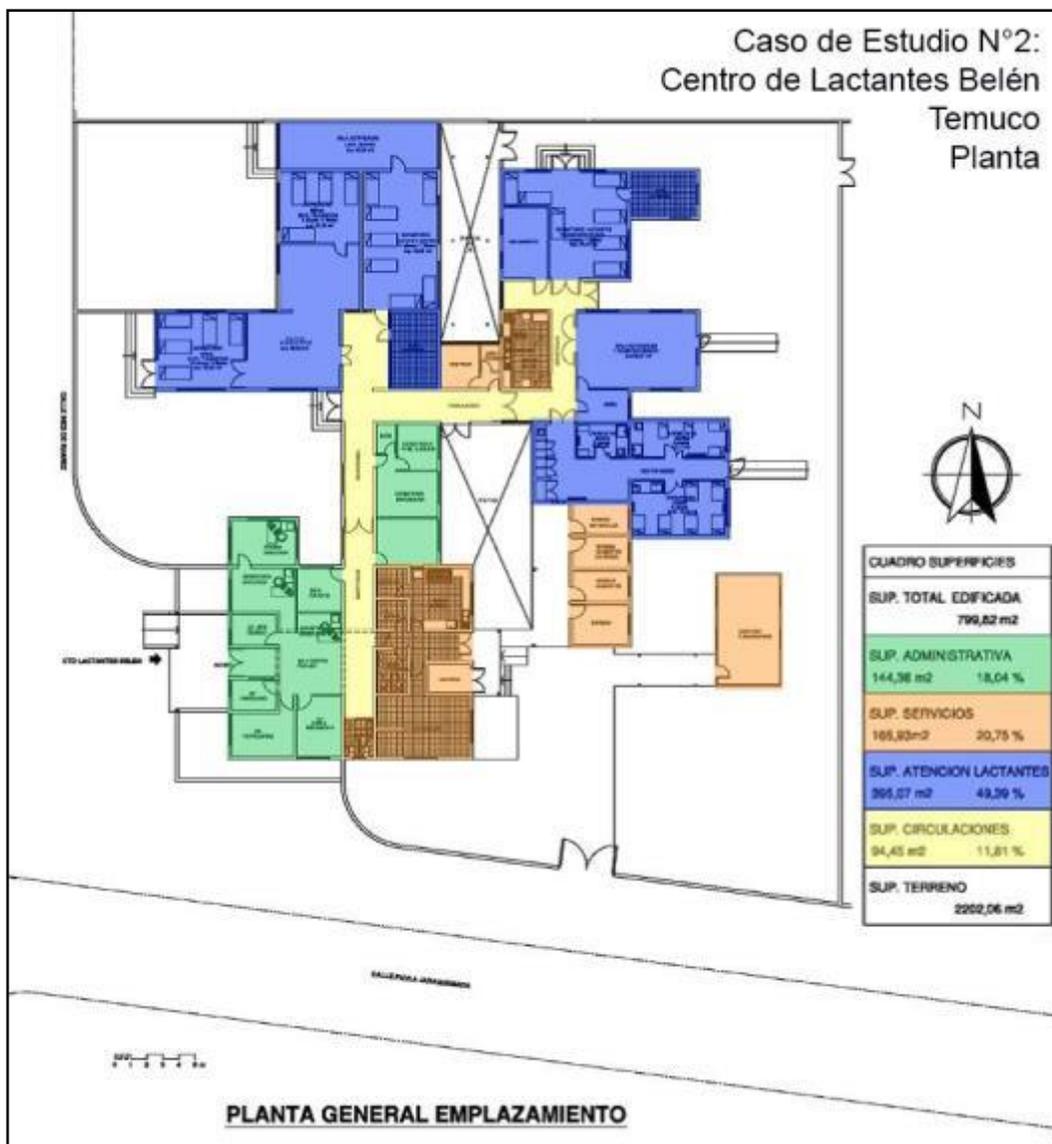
Plantas Centro de Lactantes Belén, Temuco. Fuente: Elaboración propia con informaciones planimétricas de la Unidad de infraestructura del SENAME.
